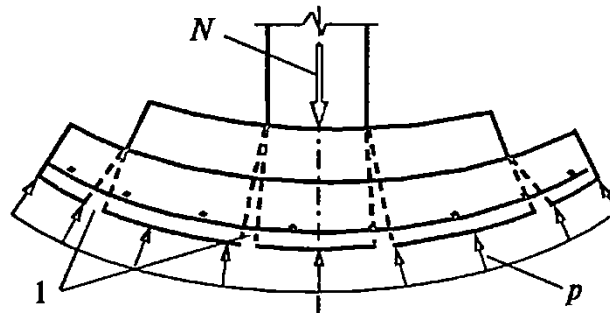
Характер деформации фундамента: 1 – трещины
